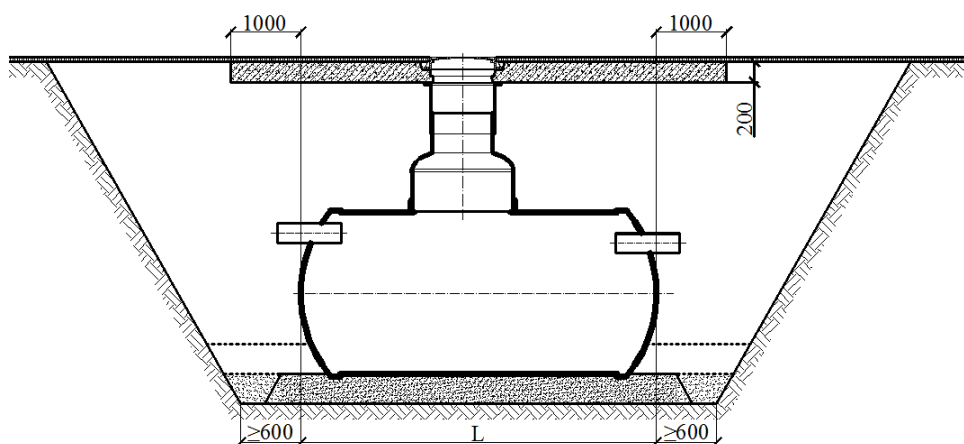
Схема расположения горизонтального корпуса в зоне наезда транспорта с низким уровнем грунтовых вод
